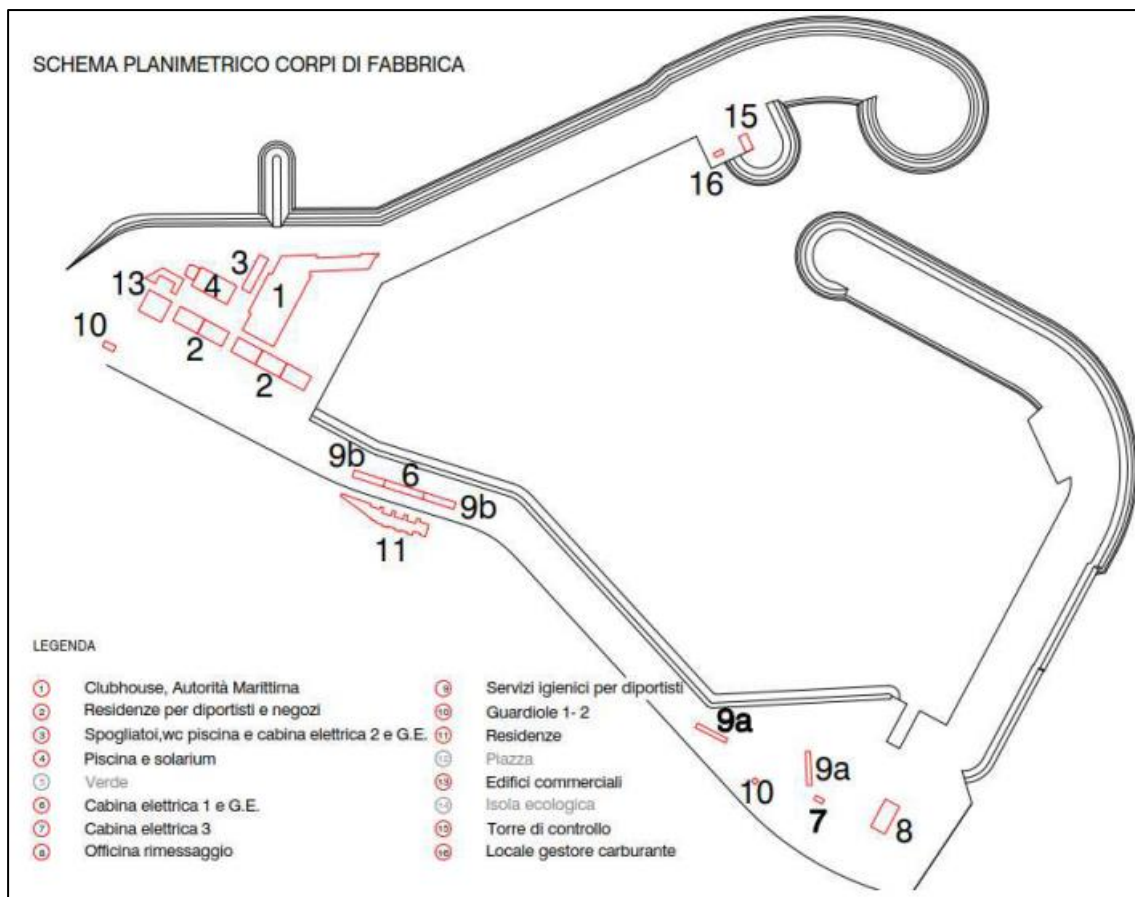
Schema planimetrico dei corpi di fabbrica previsti.
